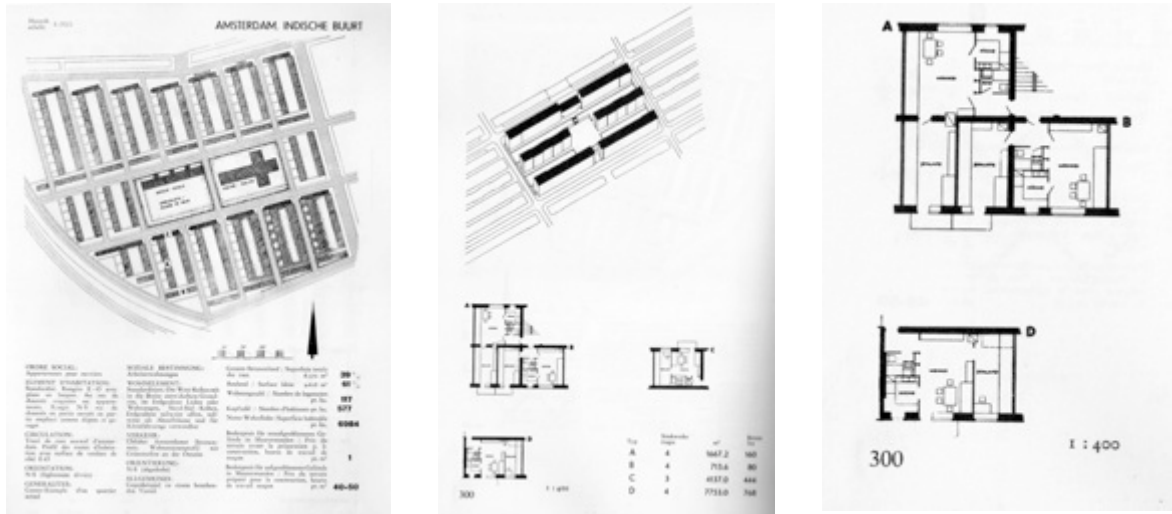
Proyecto en Ámsterdam. Bloques de vivienda en unidades mínimas.
